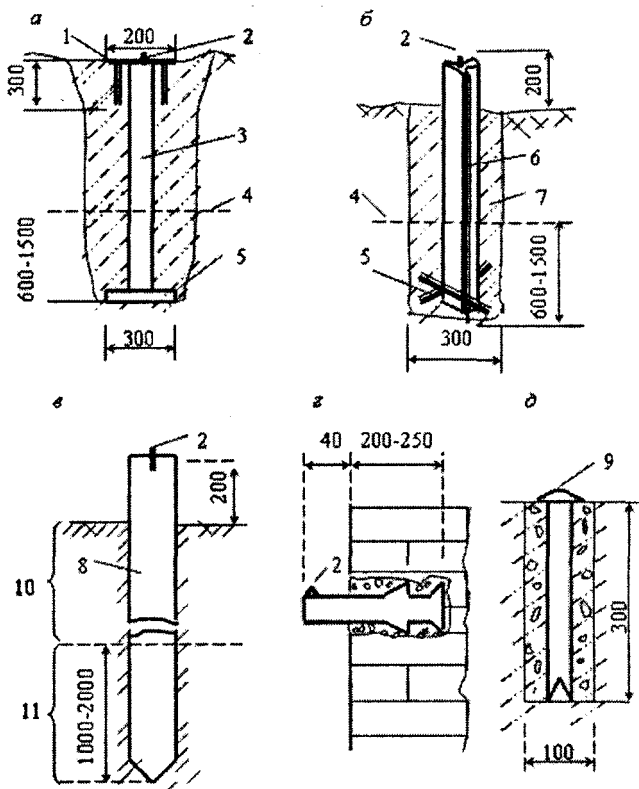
Схемы знаков: *a, б* – для зоны сезонного промерзания; *в* – для закладки ниже зоны рыхлых грунтов; *г* – для заложения в капитальные сооружения; *д* – для заложения в бетонные покрытия; 1 – пластина 200x200 мм; 2 – выступ координатный; 3 – труба диаметром 50-70 мм; 4 – зона промерзания грунтов; 5 – якорь; 6 – рельс; 7 – скважина под бур; 8 – свая; 9 – сферическая поверхность; 10 – толщина рыхлых грунтов; 11 – глубина погружения сваи в устойчивые грунты
